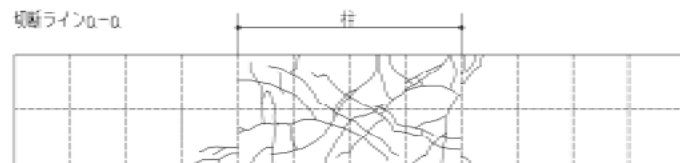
コンクリートのひび割れベクトル (a-a 断面)
